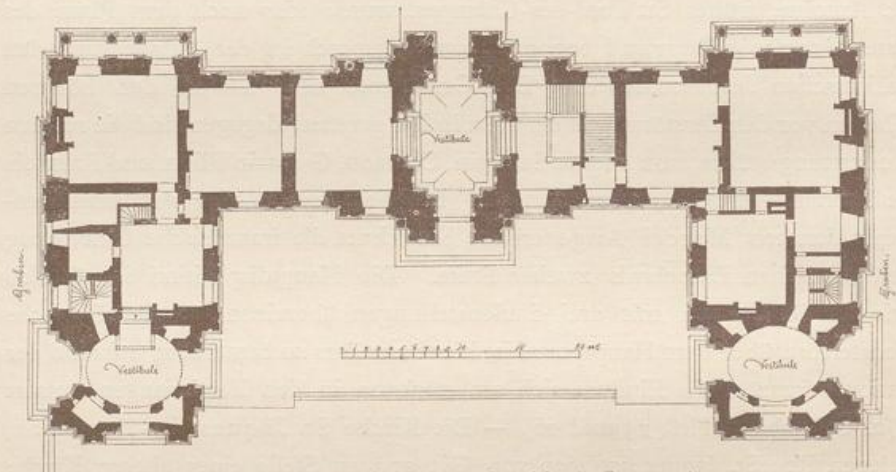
Schloss de Maisons. Grundriss (n. Sauvageot).
